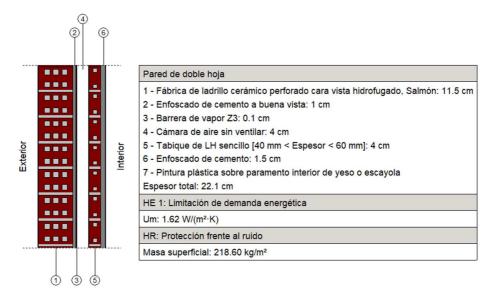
Detalle constructivo de cerramiento planta baja, ladrillo cara vista.46
